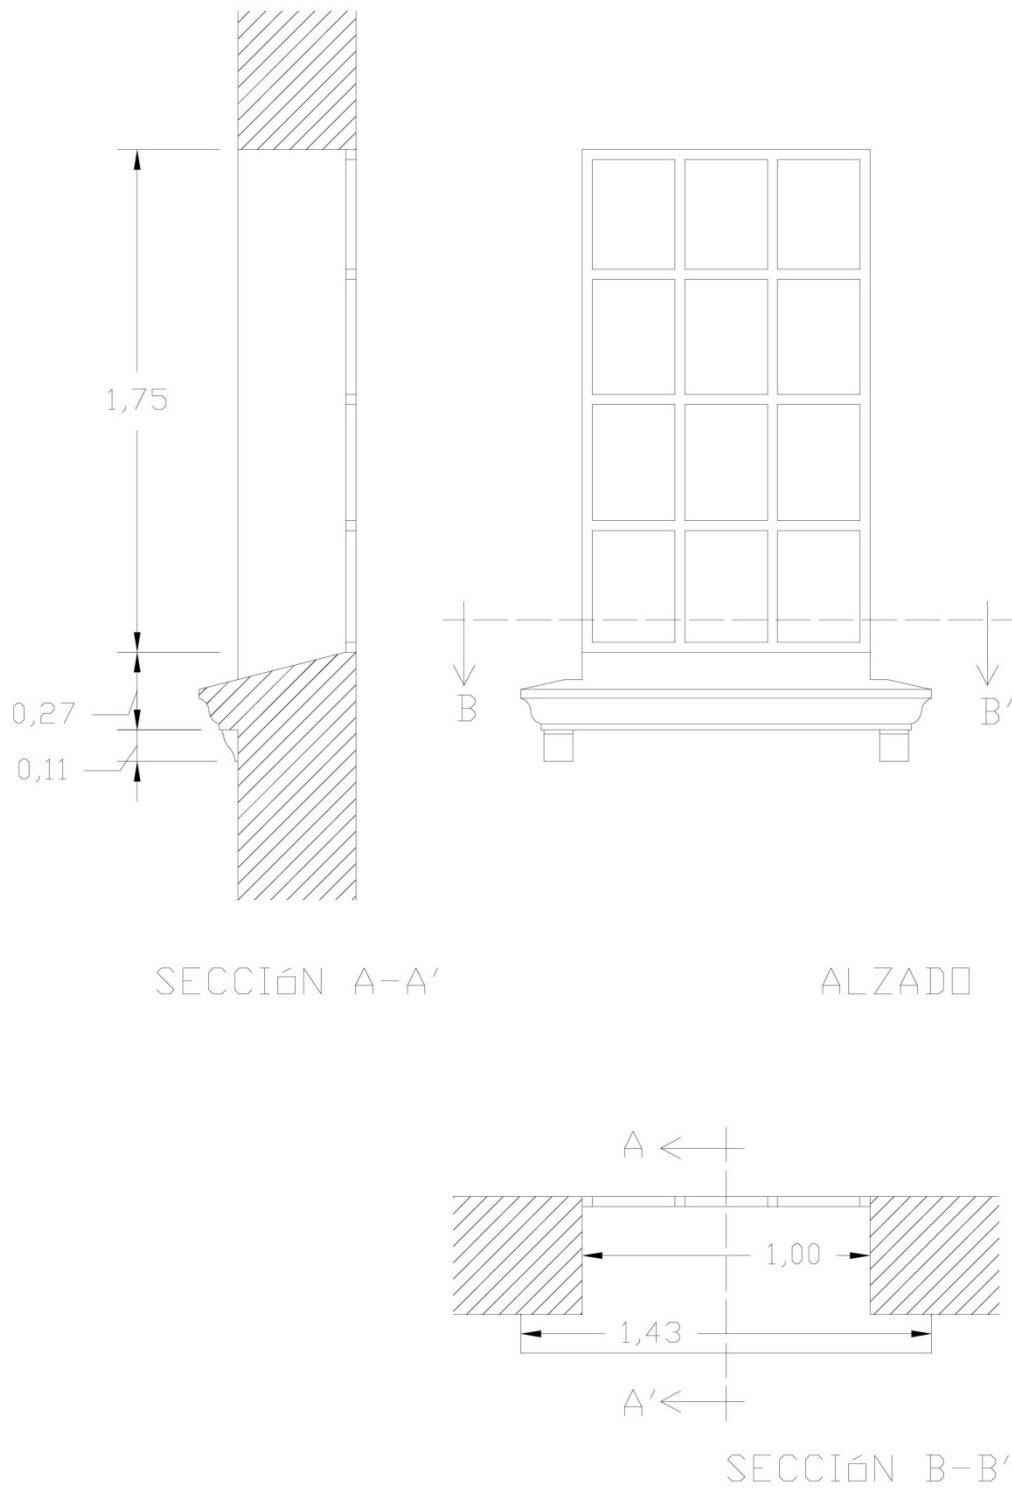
Detalle de las ventanas de la fachada Este en planta baja.
